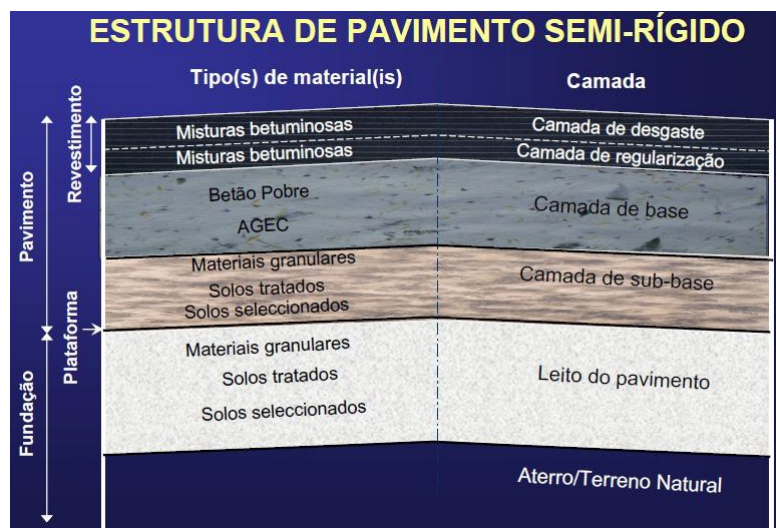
Estrutura de pavimento semi-rígido (Antunes *et al.*, 2005)
